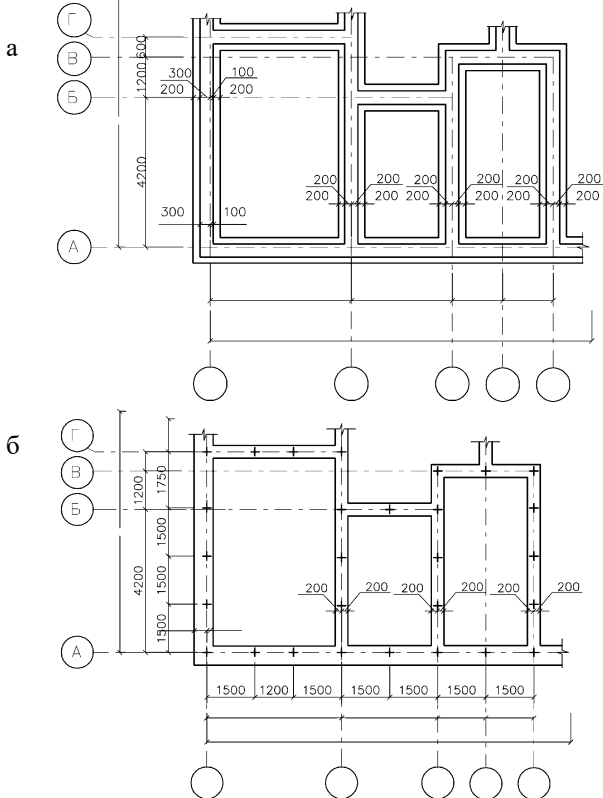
Особенности проектирования фундаментов: а – фрагмент монолитного фундамента; б – свайный фундамент
